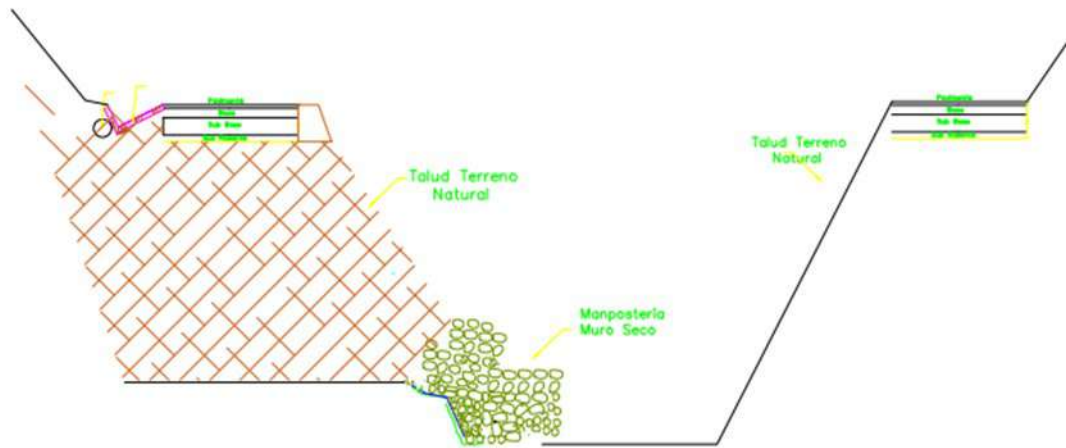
Detalle de construcción de muro seco en la progresiva Km 00+320 Km 00+345 (Fuente: Elaboración Propia)
